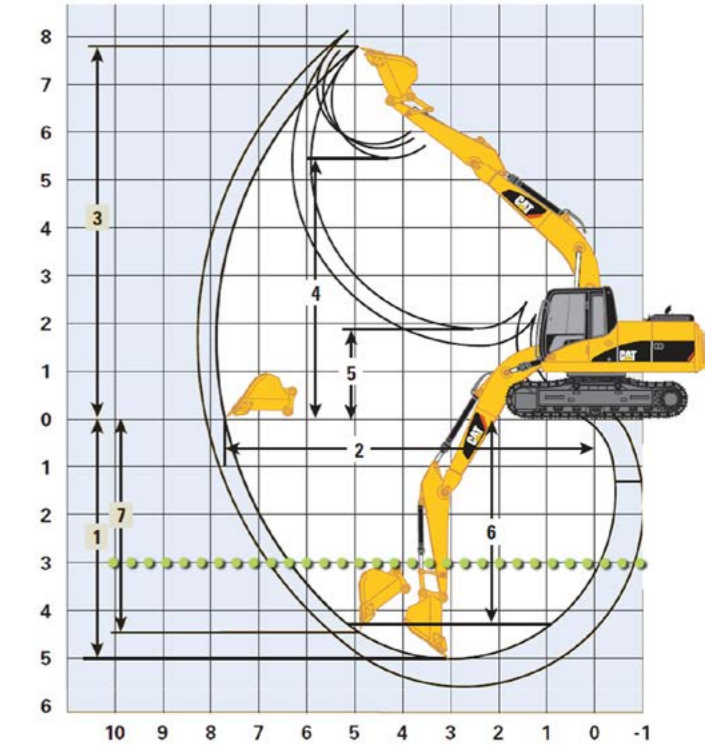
Sezione esplicitiva delle caratteristiche dell'escavatore.
